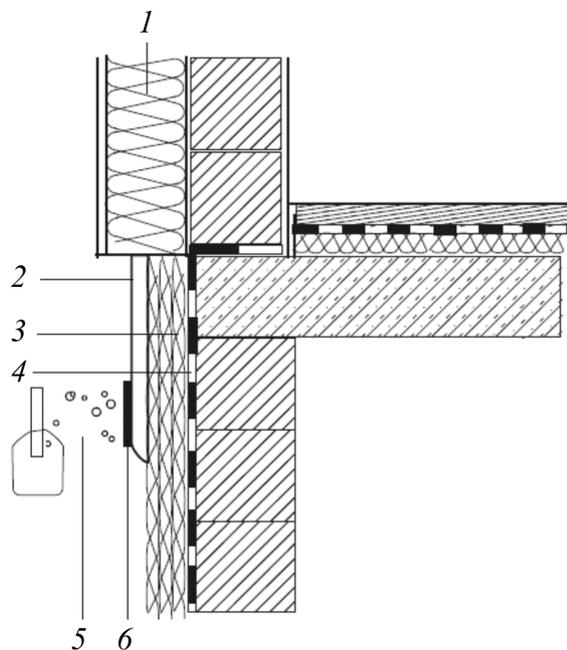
Пример защиты утеплителя цоколя от воздействия окружающей среды: 1 – система наружного утепления стены; 2 – цокольная штукатурка; 3 – экструдированный пенополистирол; 4 – гидроизоляция фундамента; 5 – гравий; 6 – гидроизоляция битумной мастикой [2]
